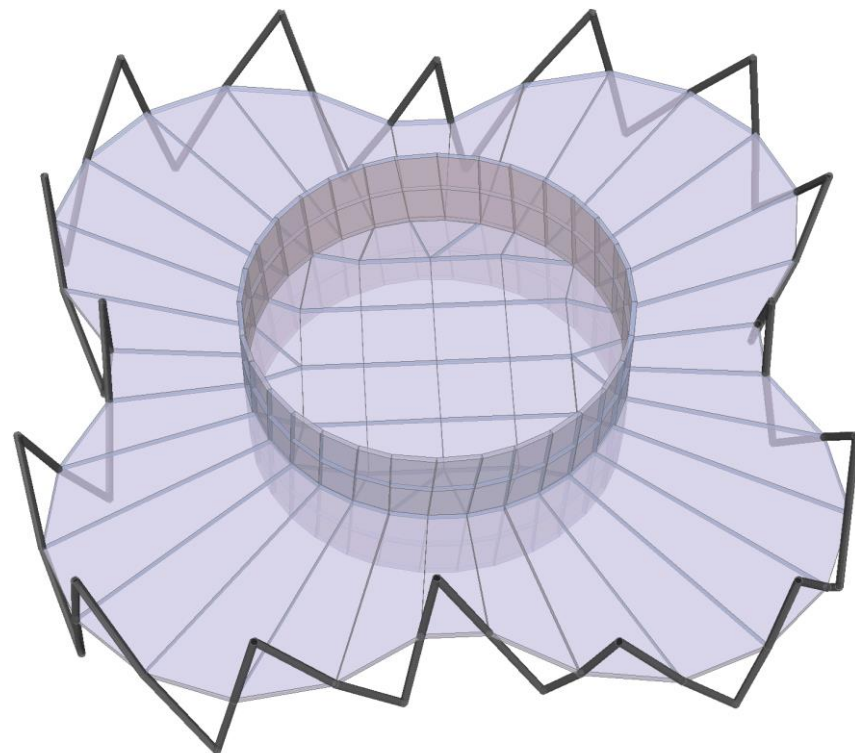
Detalle de una planta tipo, aquí se puede ver la discretización de los forjados del edificio, del núcleo, del muro del núcleo y de los soportes metálicos.
